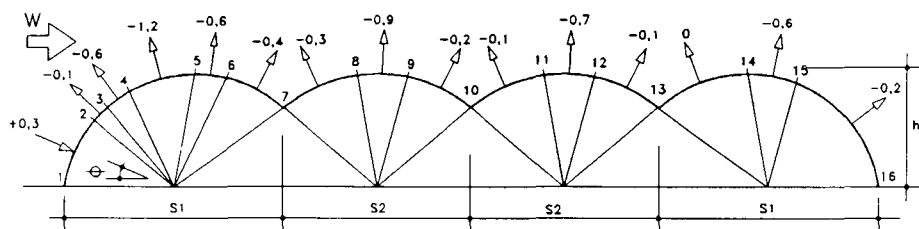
A Vormfactoren C_d en C_z voor tunnels met een hoogte/breedteverhouding $h/s = 0,5$ bij een windrichting loodrecht op de kaslengte
